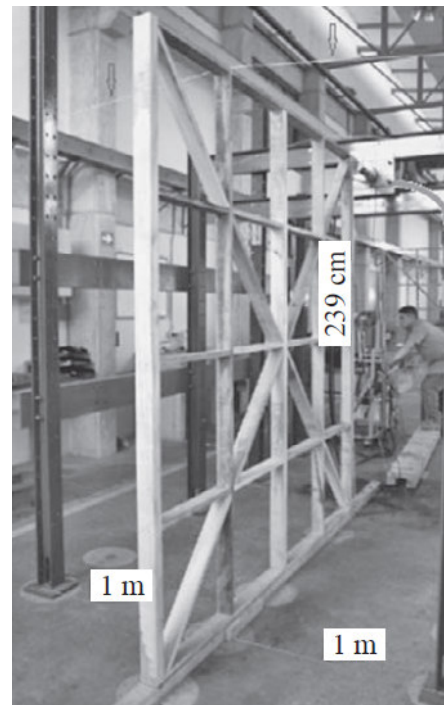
Vigas de carga y cimentación, Alejandro Robles
